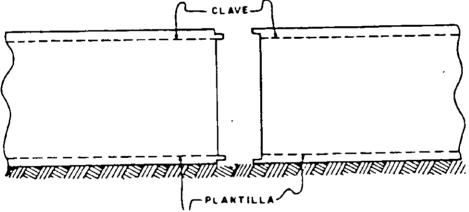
Unión espiga y caja en tubería de concreto reforzado
